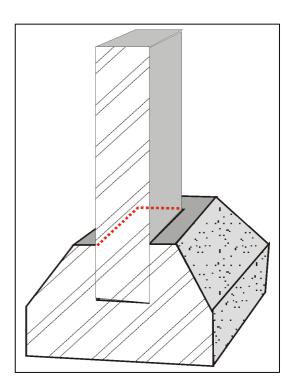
Detalhe da inserção do pilar no elemento de fundação
